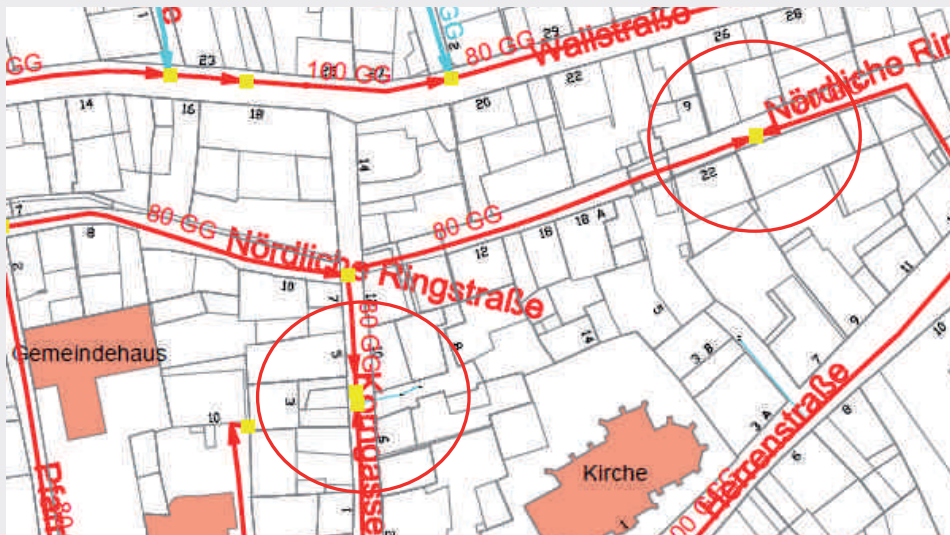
Bereiche mit Pendelleitungen und «stehendem» Wasser
